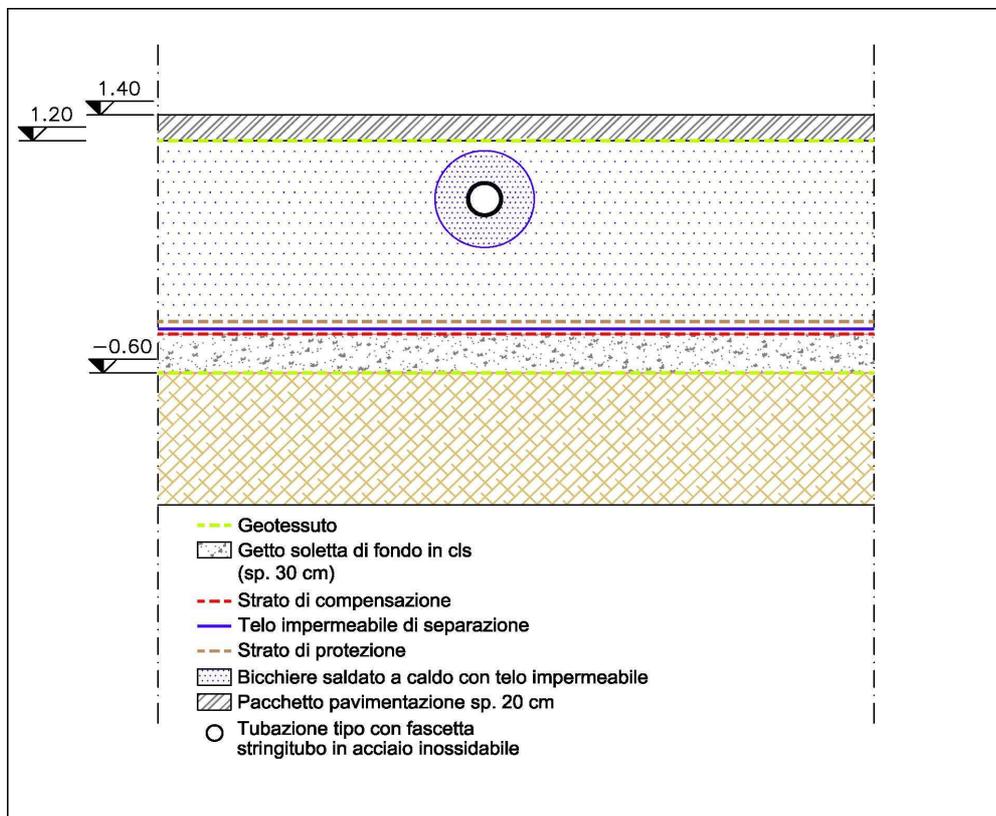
Prospetto tipo intersezione tubazione con palancole
